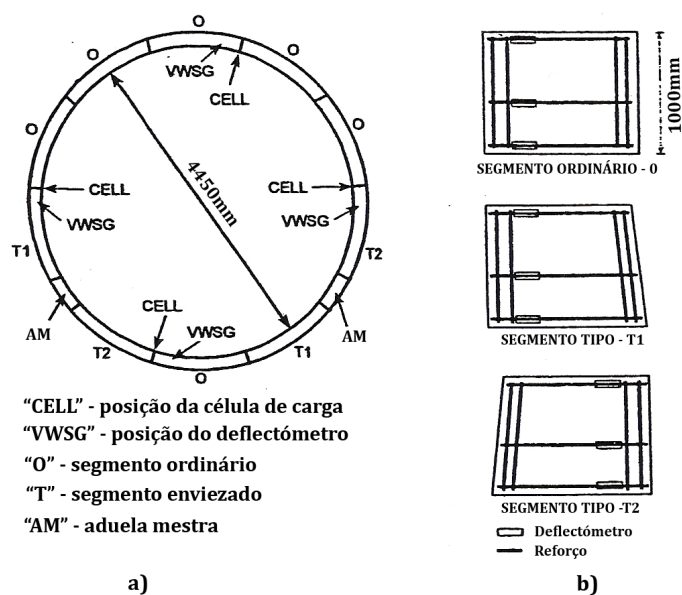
Instrumentação do suporte: a) localização dos equipamentos b) pormenores da instalação dos defletores (adaptado de Nyren, 1998).
